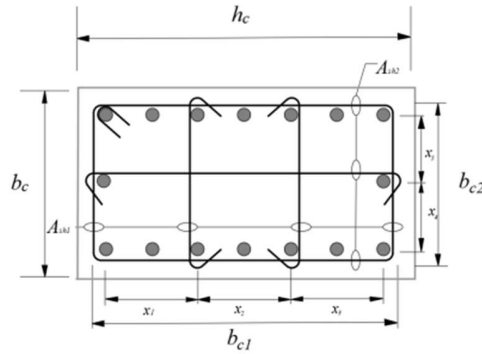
Arreglo de aceros de refuerzo longitudinal y transversal. Fuente: Ceballos, 2022.
